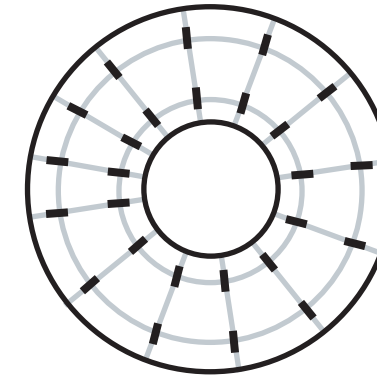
Esquema planta estructuras niveles -1 y -2. Fte.: Elaboración propia
